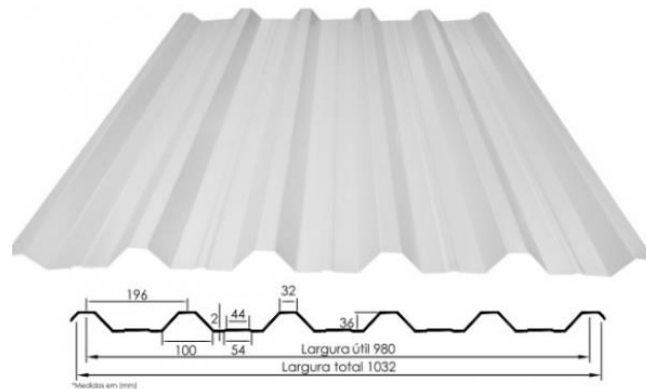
Telha de alumínio trapezoidal, esp. 0.5mm.
